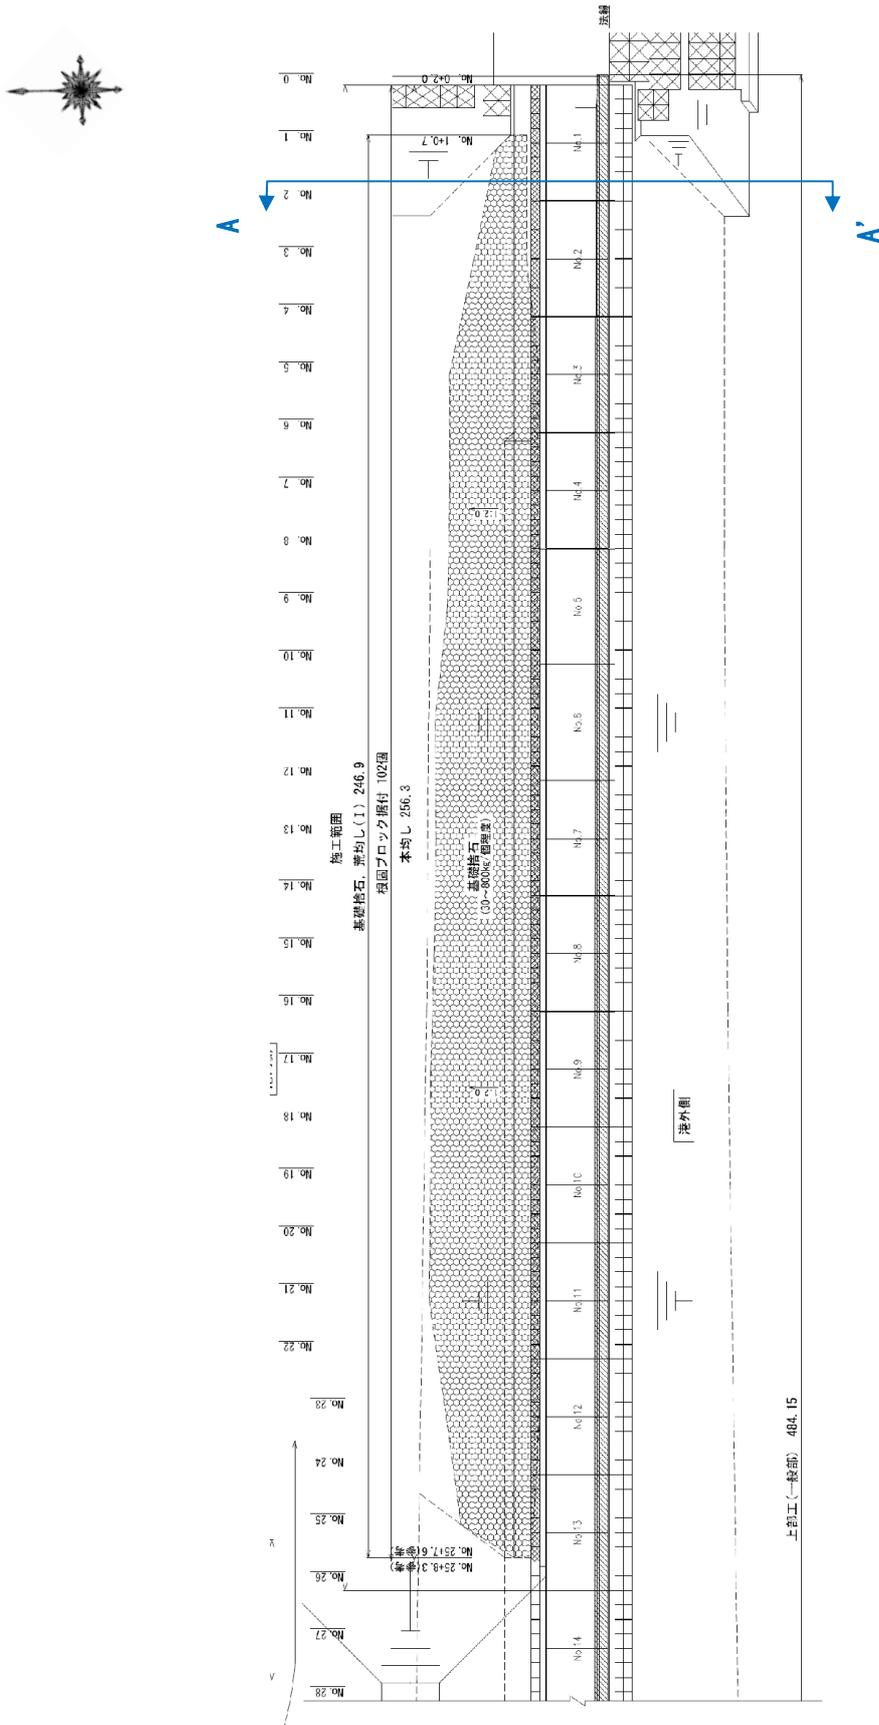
No.1 常陸那珂港区_北防波堤平面図② (復旧後)
